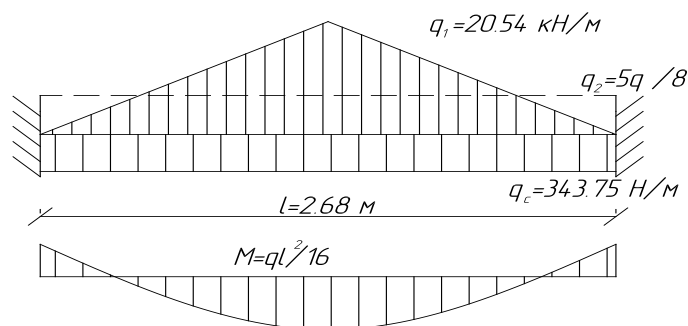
Розрахункова схема поперечного ребра і епюра згинних моментів.
